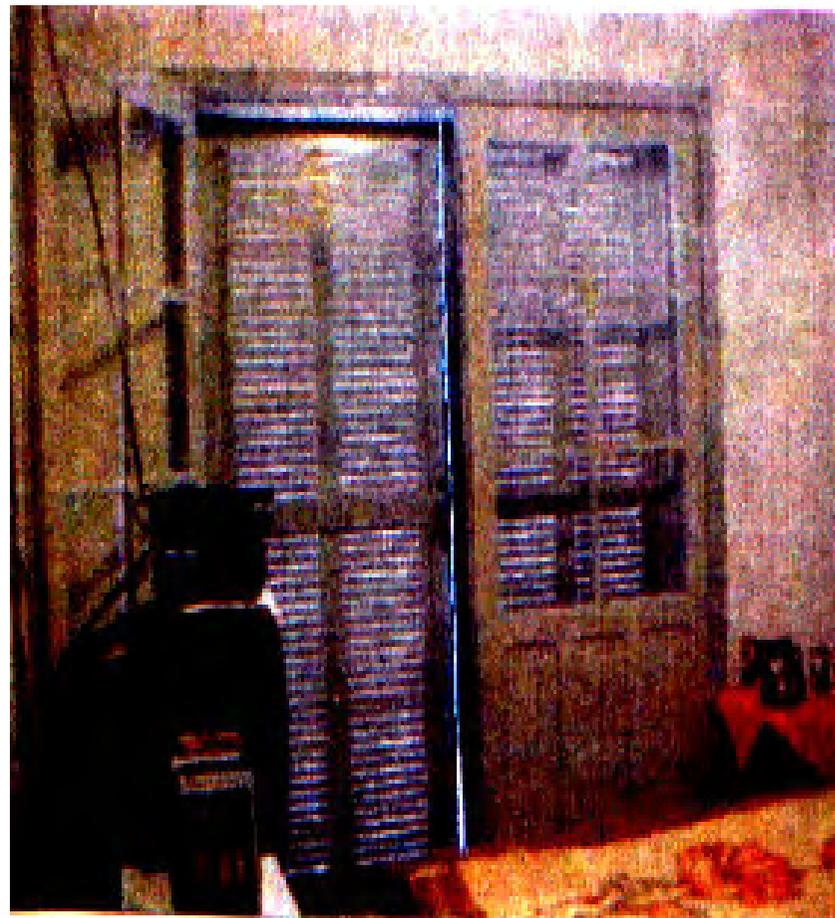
Porta-janela de apartamentos da fachada sul do Hotel Águas de Santa Clara. Fonte: Foto Sonia Pessa de Oliveira
